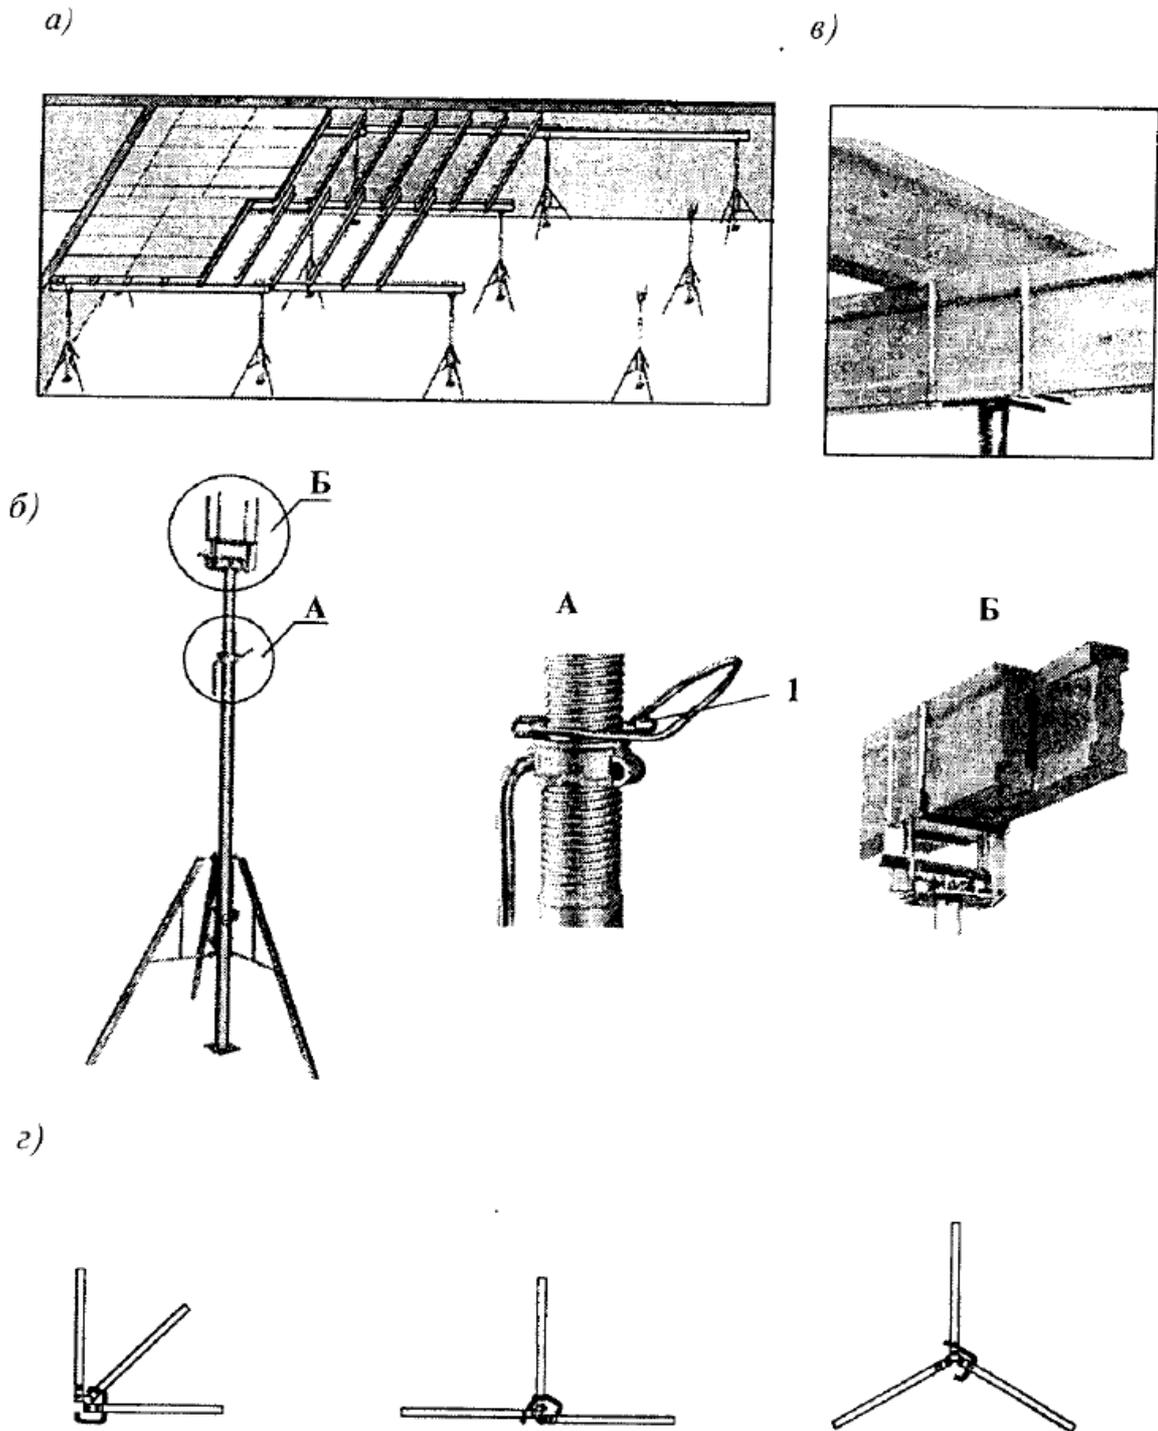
Опалубка перекрытий «Компакт» фирмы «Тиссен»:
